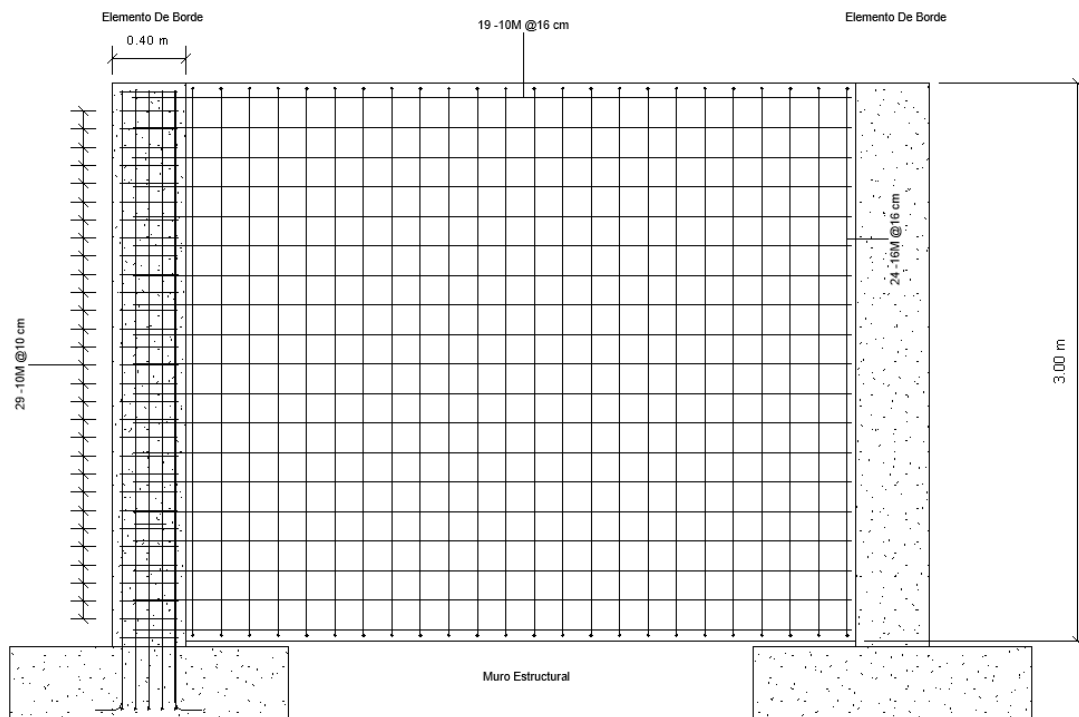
Dimensiones y armado de refuerzo del muro estructural para el sistema de 6 pisos
